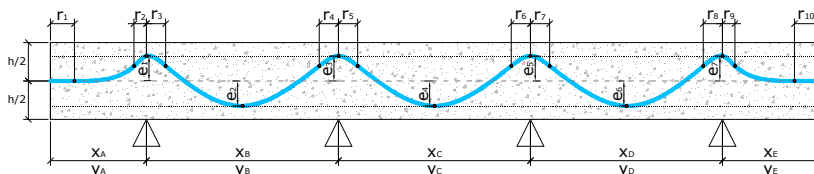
Traçado Genérico dos Cabos em Elevação
